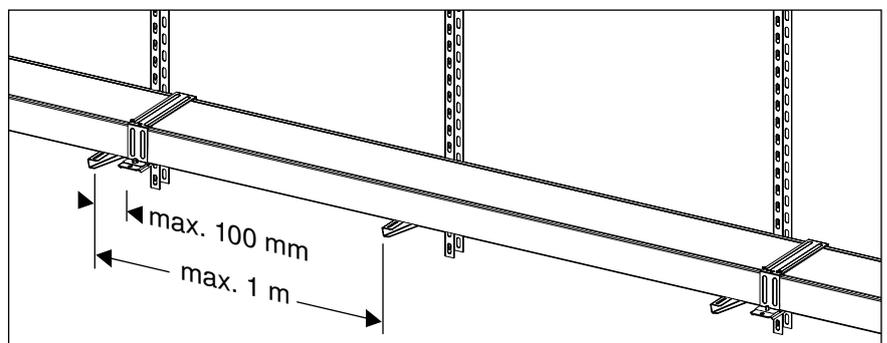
Beispiel für Streckenführung auf Stiel/Ausleger
